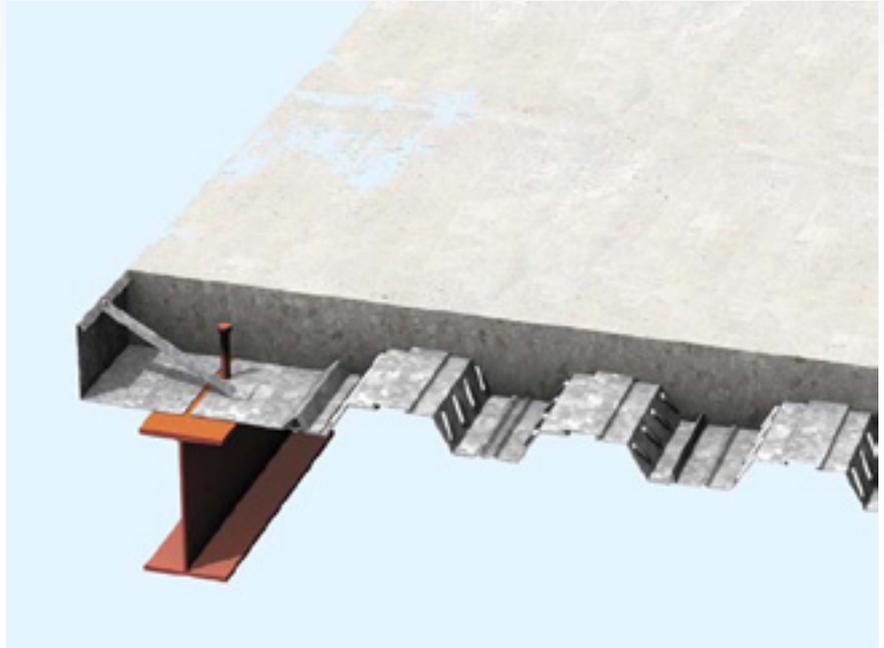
Крайняя балка в перекрытии композитной конструкции
